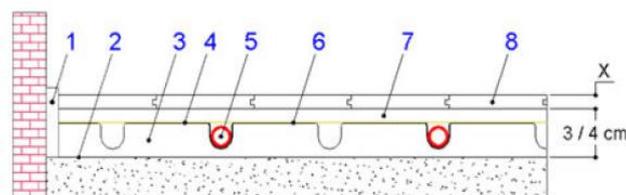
Pavimento radiante ("a seco"), Fabricante: Giacomini
